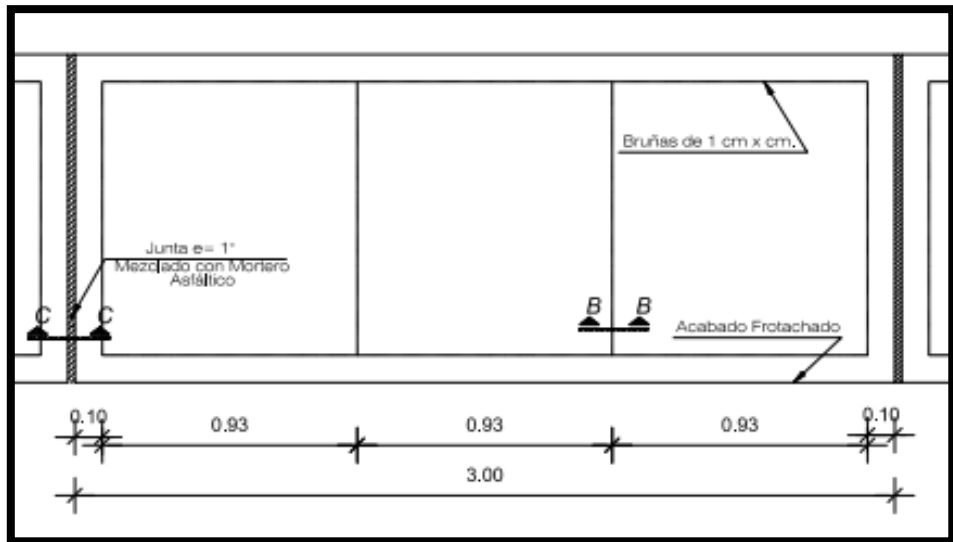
Detalles de vereda, junta de dilatación y bruñado.
